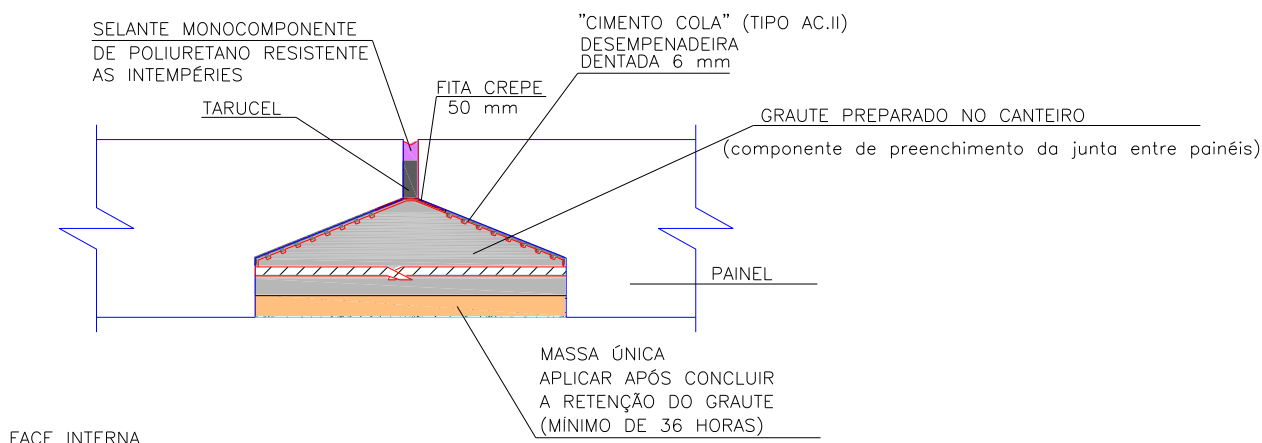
Desenho esquemático da ligação entre painéis e do tratamento das juntas
